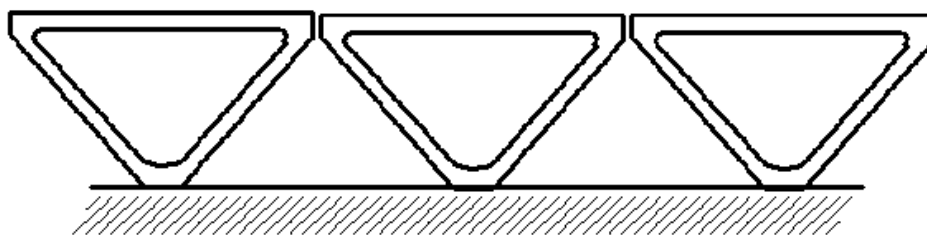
Поперечное сечение перекрытия из сборных плит полого треугольного сечения
